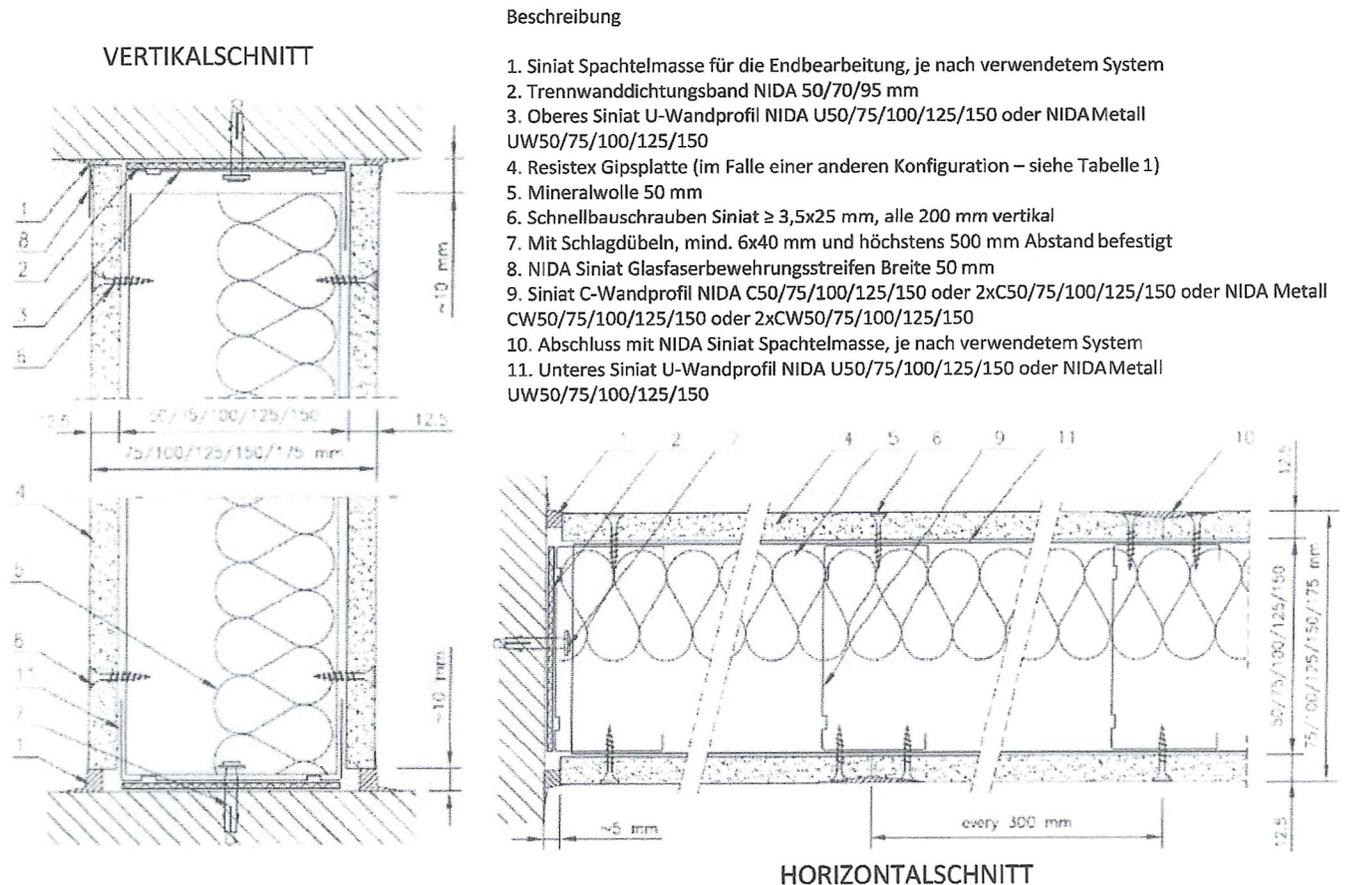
Vertikal- und Horizontalschnitt von einbruchshemmenden nichttragenden einlagigen Trennwänden mit einfachem Ständerwerk
